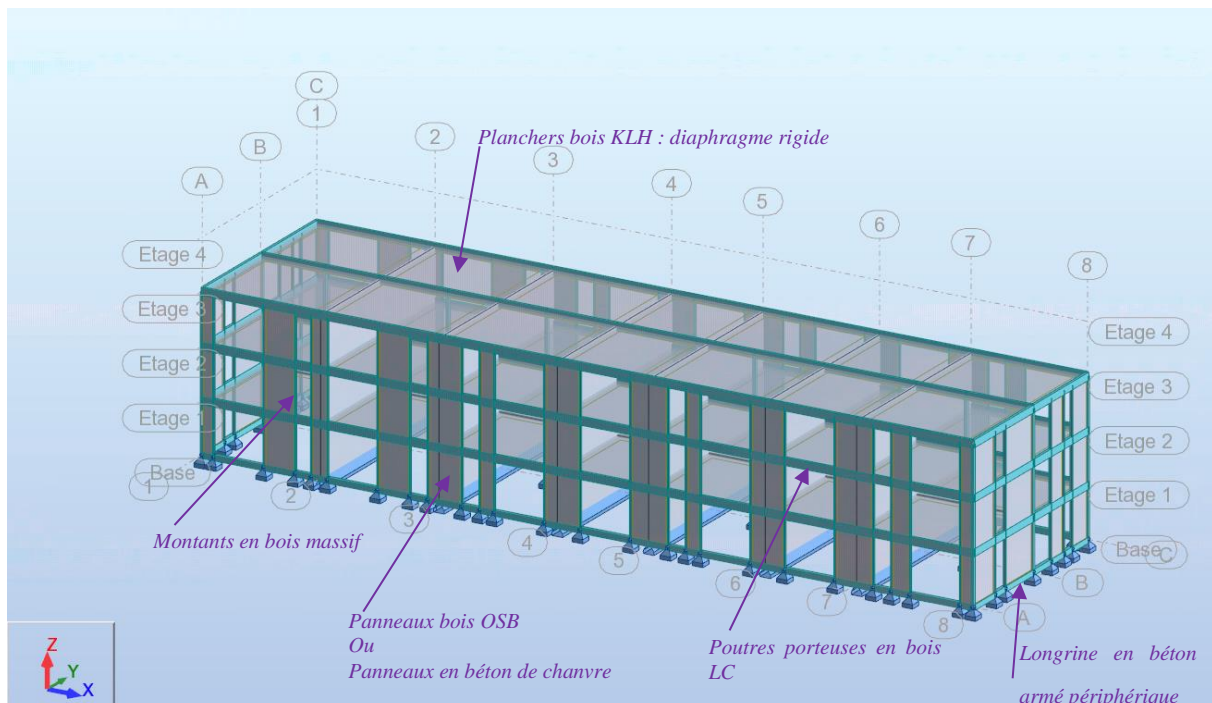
Vues générales de la structure modélisée : Montants et poteaux en bois massif, poutres en bois lamellé collé – refends en bois KLH – Plancher en bois KLH.
